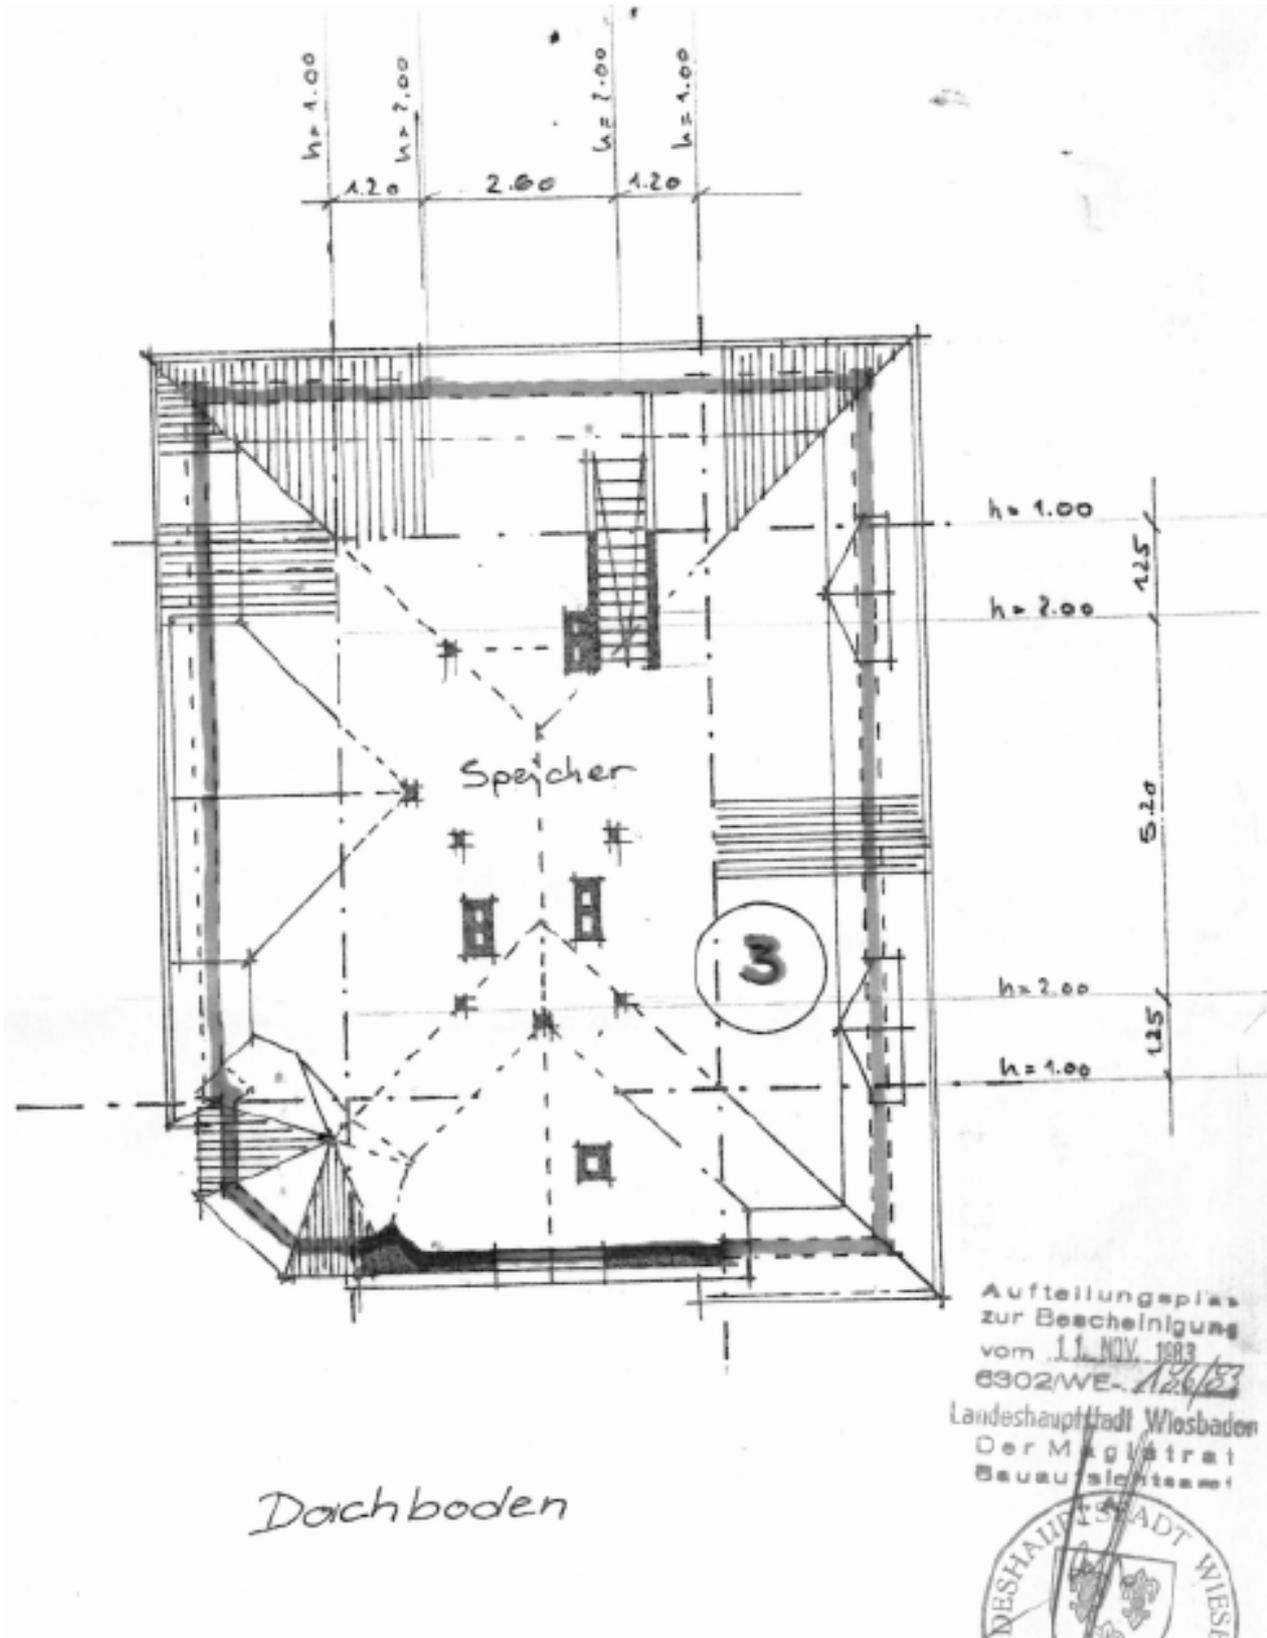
Grundriss Speicher Wohnung Nr. 3 (ohne Maßstab); Quelle: Grundakte des Grundbuchamts Wiesbaden, Aufteilungspläne zur Bescheinigung vom 11.11.1983
